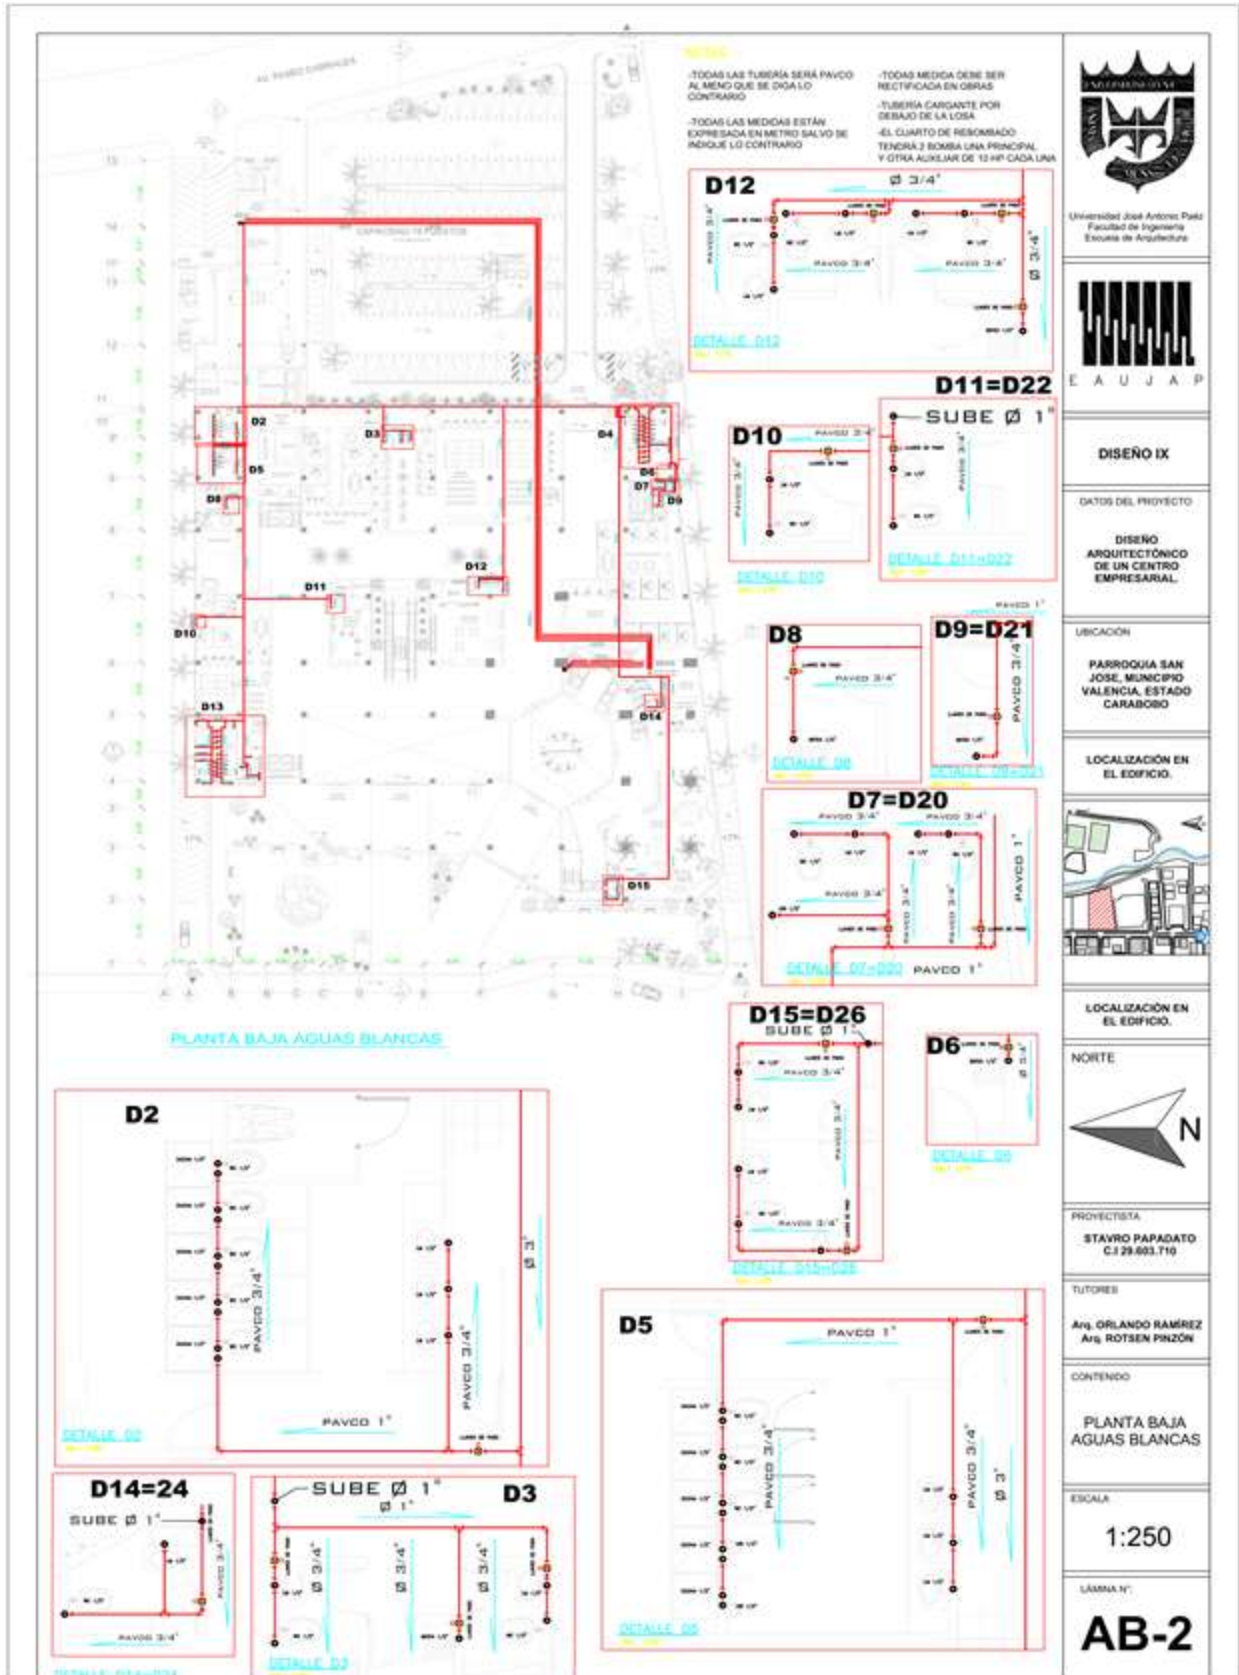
AB-2 Planta Baja Aguas Blancas. Fuente: El Autor (2023)
